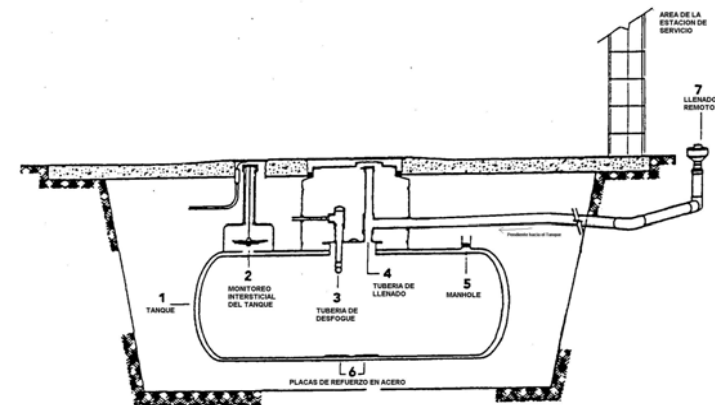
Sistema de llenado remoto. Adaptado de Shell, 1996.
